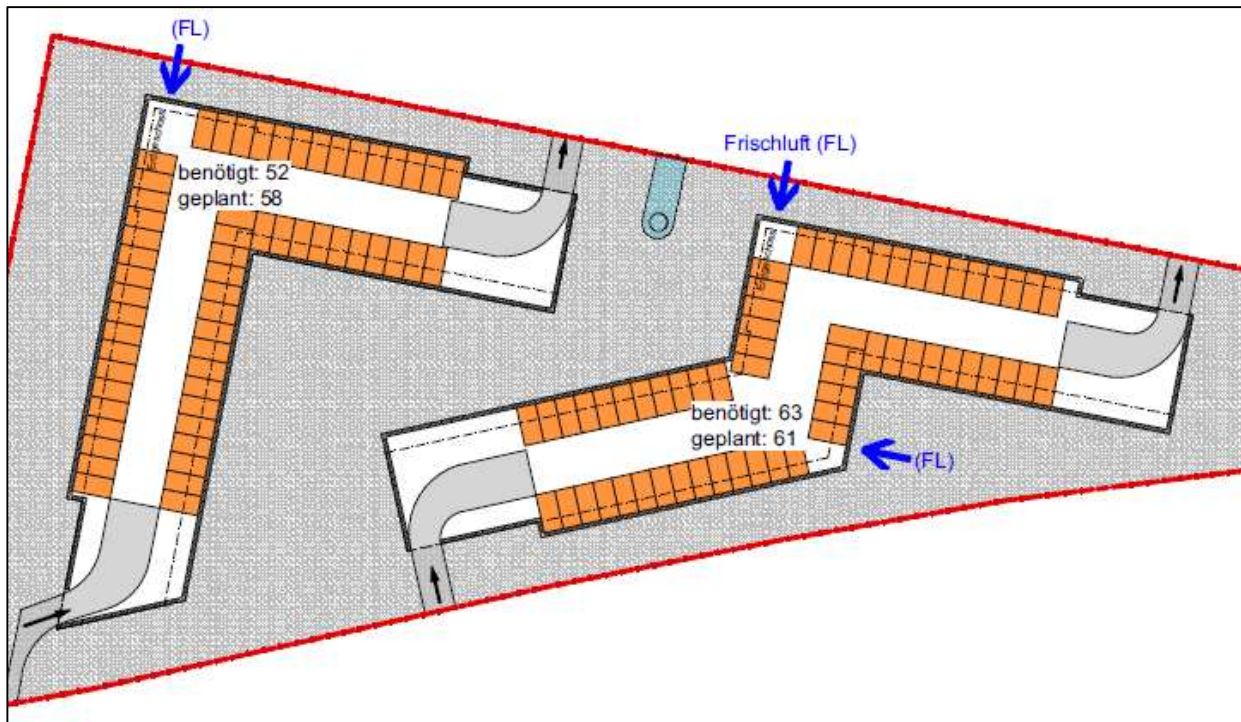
Tiefgaragenplanung zum städtebaulichen Entwurf, Stand Juni 2024
